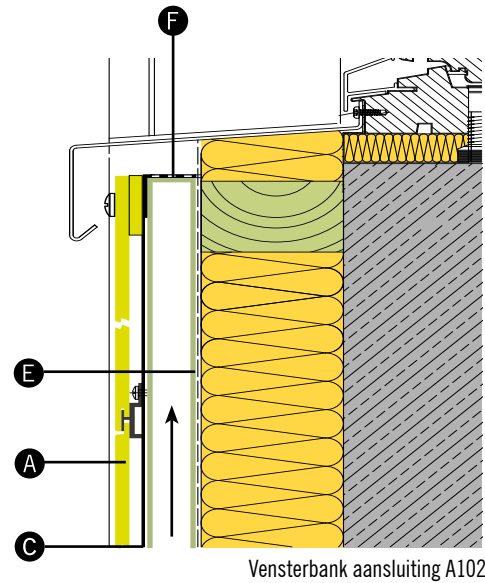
DETAILLERING: VERTICALE DOORSNEDES SYSTEEM PM05
